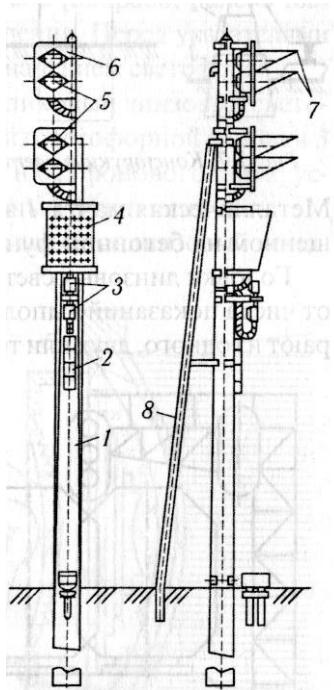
Светофор линзовый четырехзначный на железобетонной мачте
